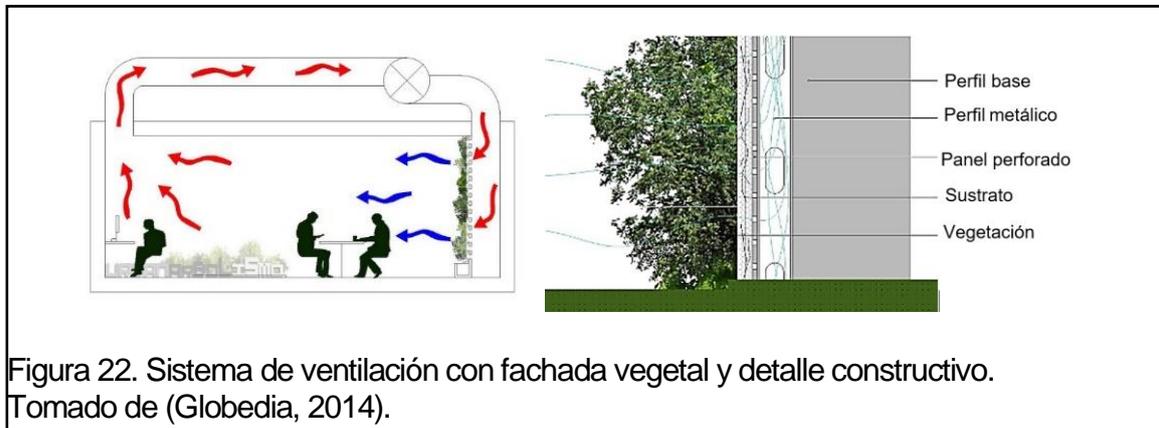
Sistema de ventilación con fachada vegetal y detalle constructivo. Tomado de (Globedia, 2014).
